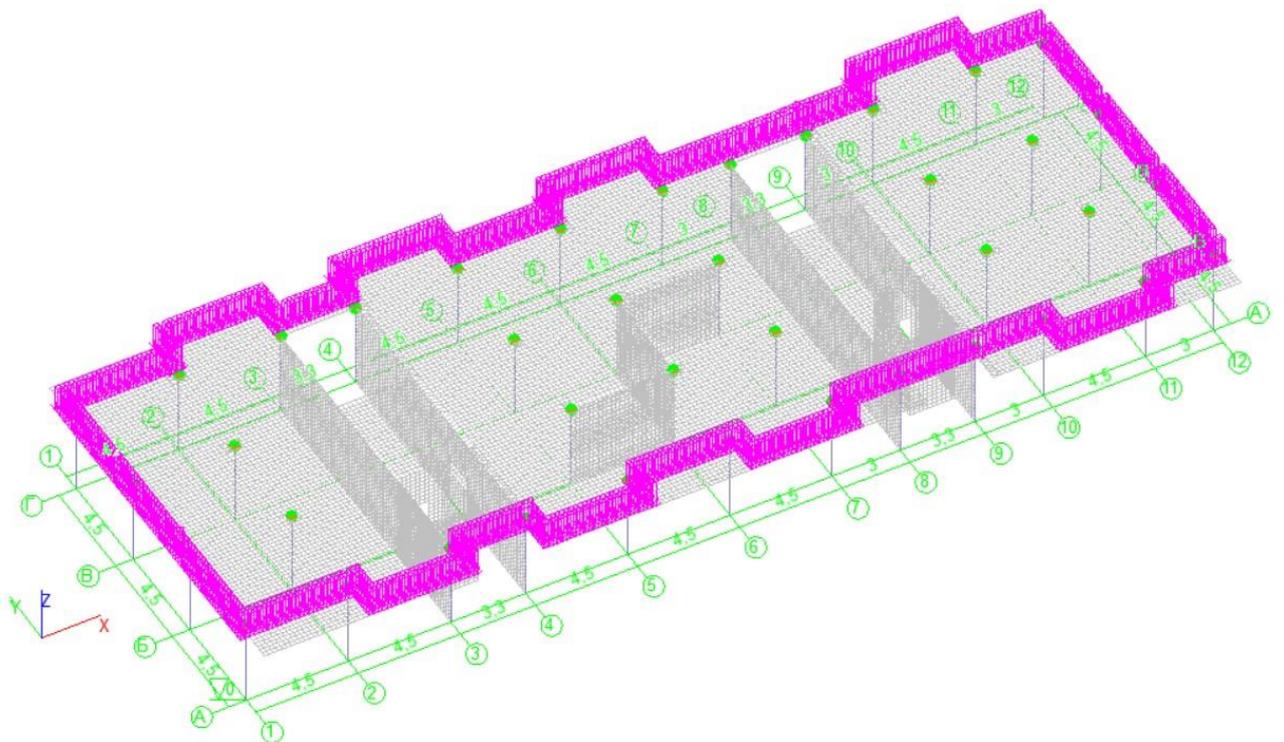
Общий вид постоянного нагружения перекрытия от собственного веса наружной стены
